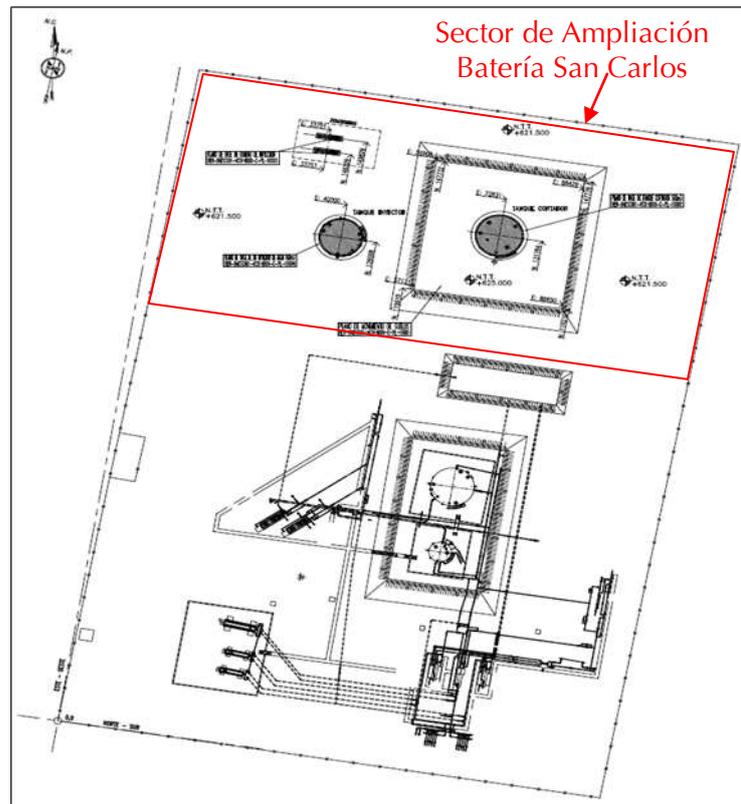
Layout general de la Batería San Carlos incluyendo el sector de ampliación (rojo).
